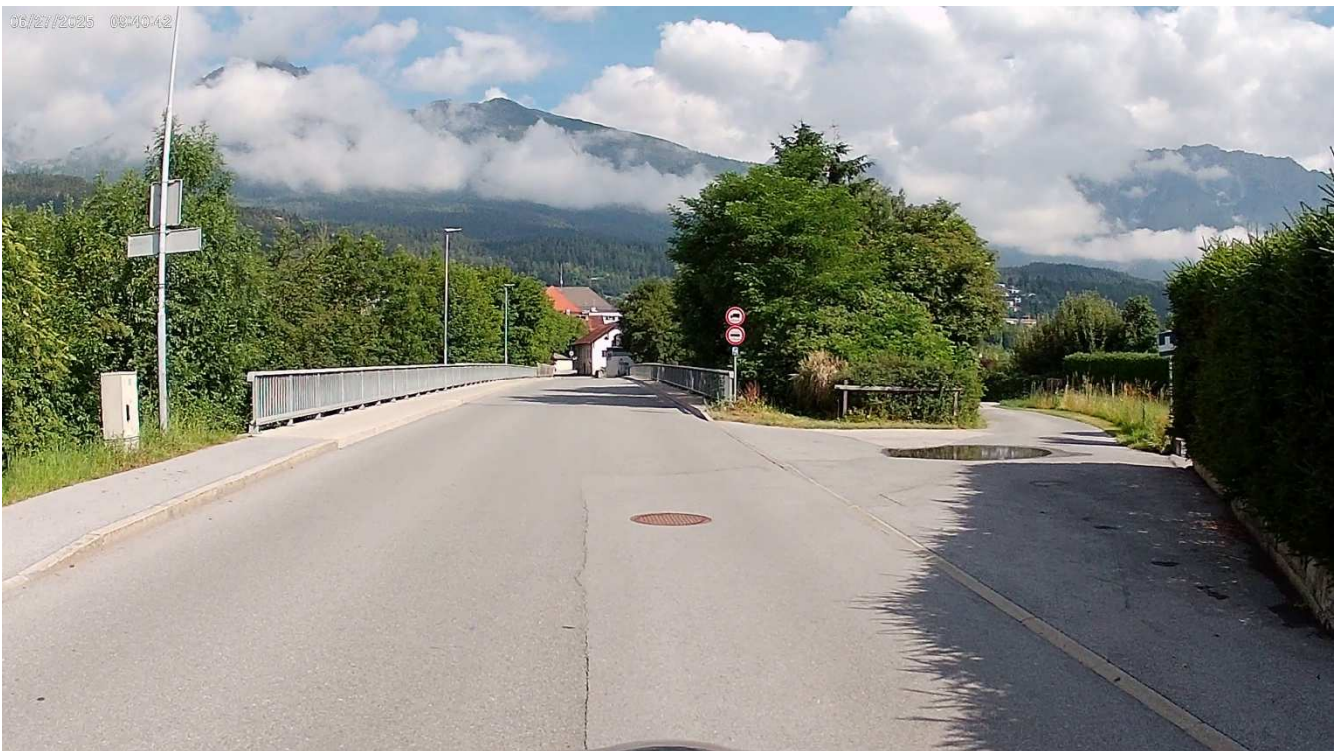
Lokalstraße vor Brücke, Blickrichtung Nordwest, rechts Zufahrt zu Gebäude Auf Arzill Nr. 17 /4/
